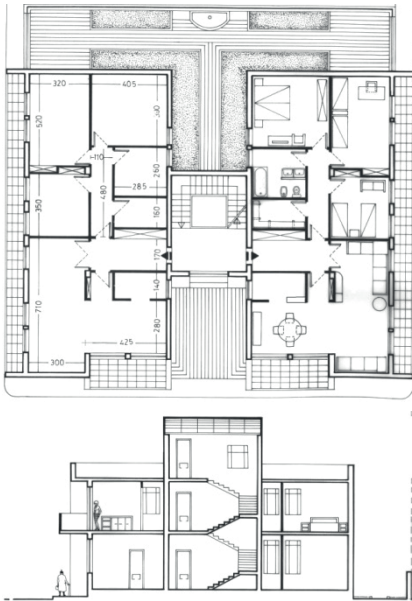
/44 – Pianta piano tipo e sezione B-B.
